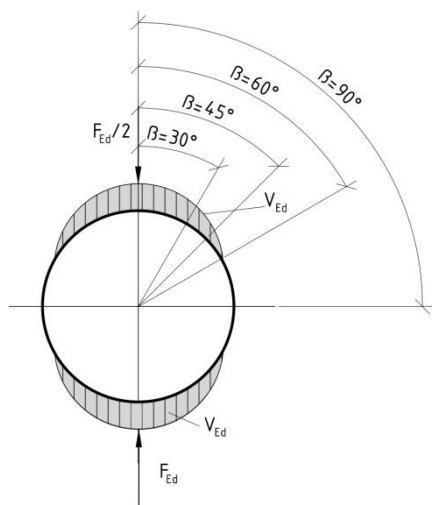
Схема з точками розрахунку поперечного перерізу водопропускної труби
